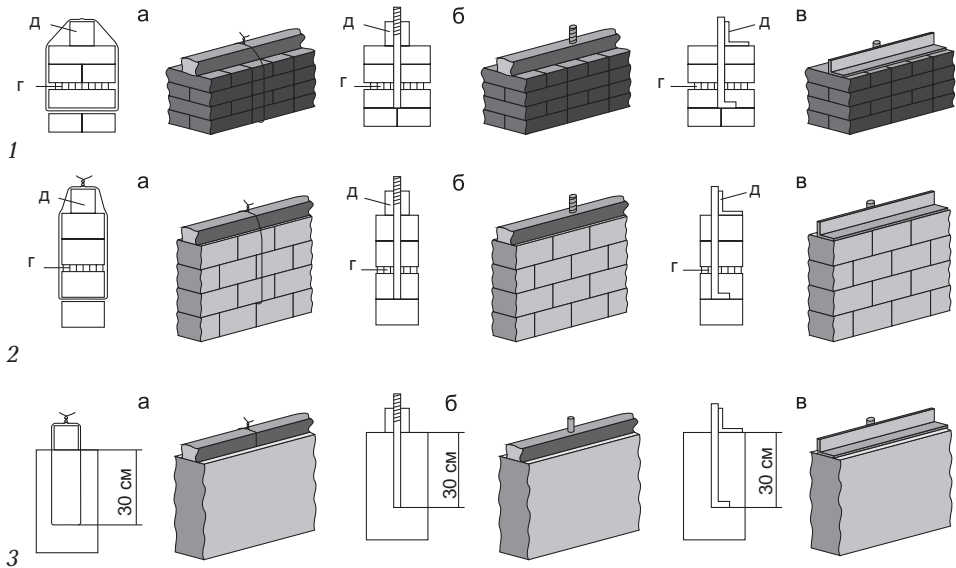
Разрезы и схемы присоединения стен к нижней обвязке теплицы: 1 — для кирпичной стены; 2 — для блочной стены; 3 — для бетонной стены; а — на проволоку; б — на анкер; в — на закладную под сварку; г — сетка-мак; д — обвязка
